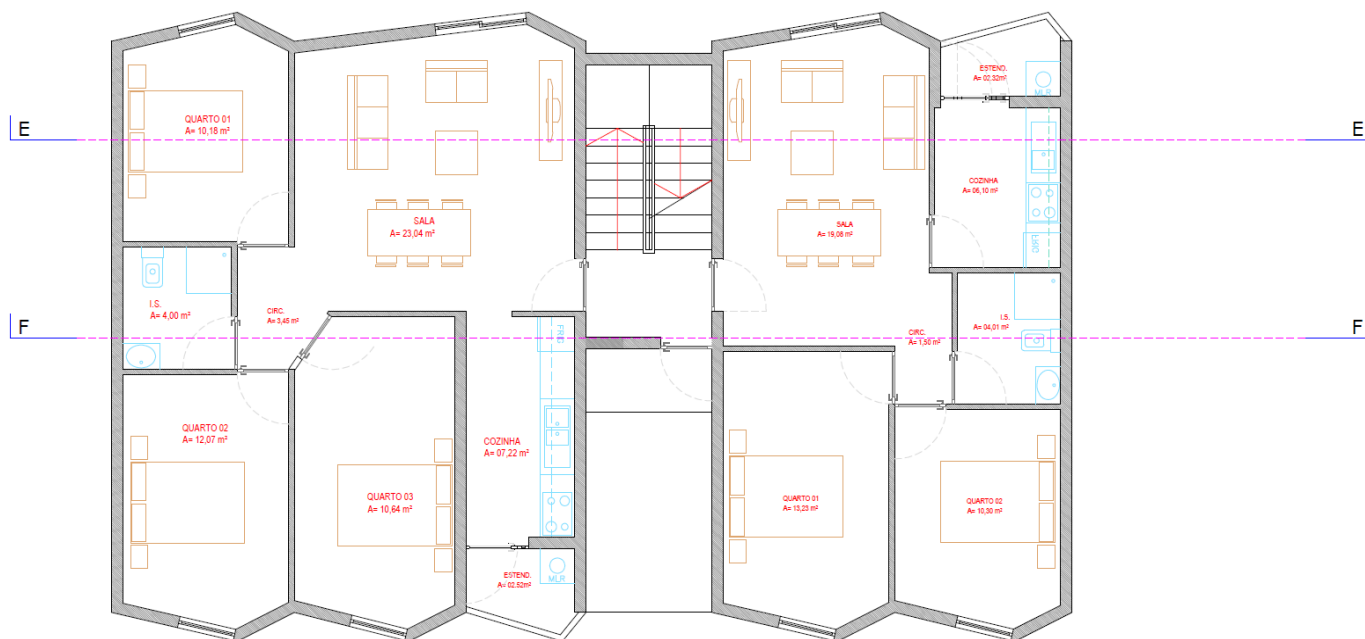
Planta do piso tipo – Caso de estudo D
